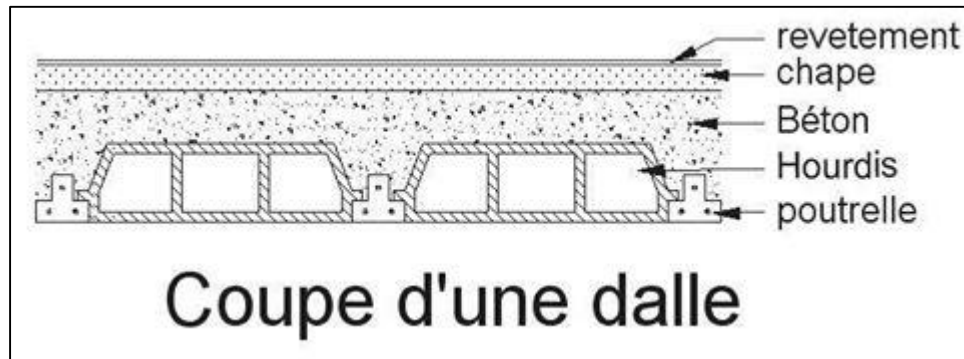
Plancher en béton armé avec poutrelles et hourdis
